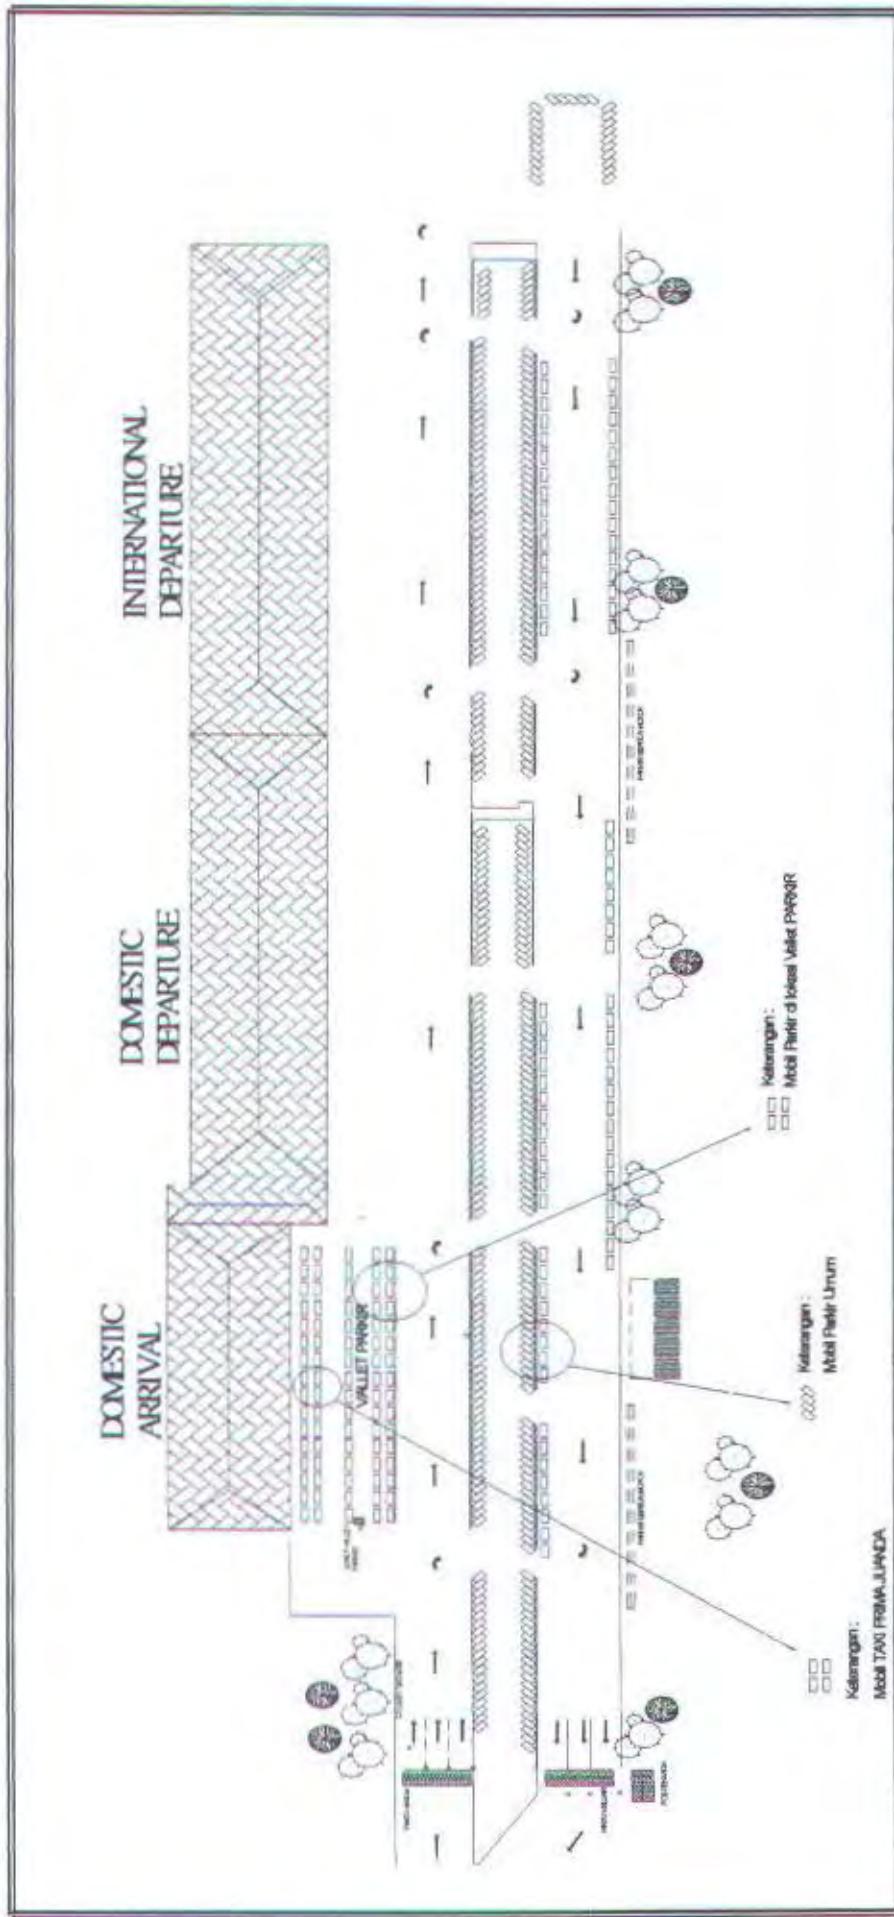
Lay out alternatif 1 lahan parkir Juanda
